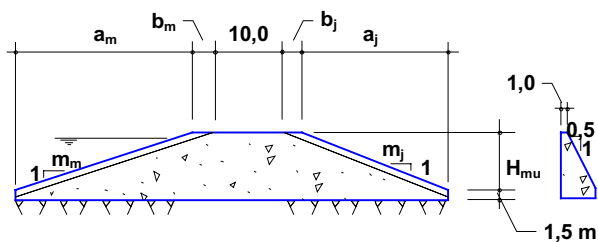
Seção típica de muro de arrimo.
